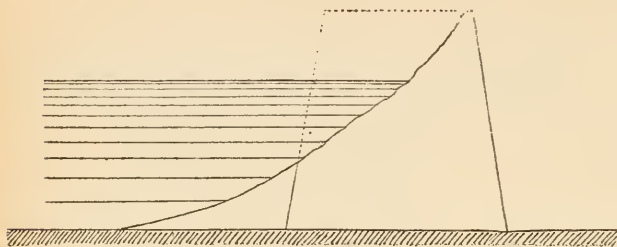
Sezione trasversale dell'argine: erosione avanzata.
